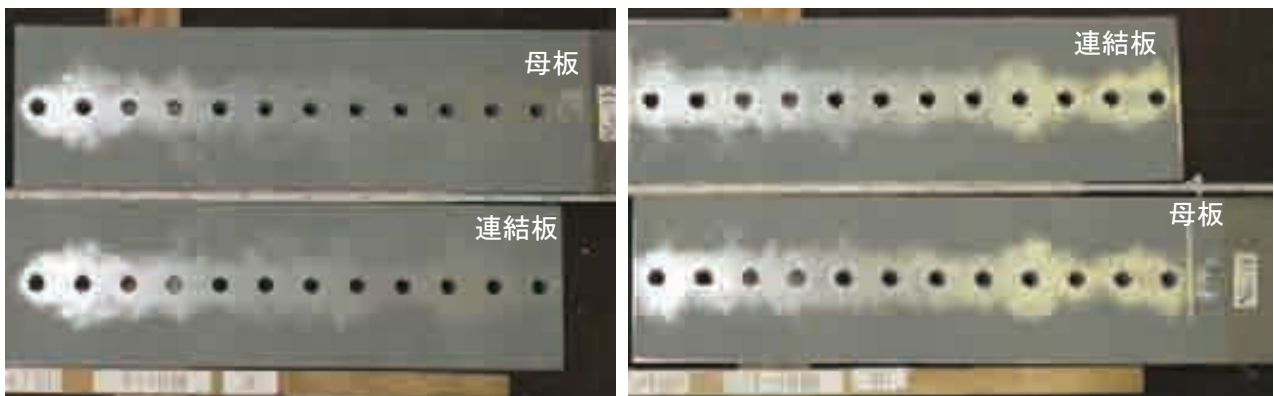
試験体 No.3-E すべり面の状況(左:ボルト側, 右:ナット側)
